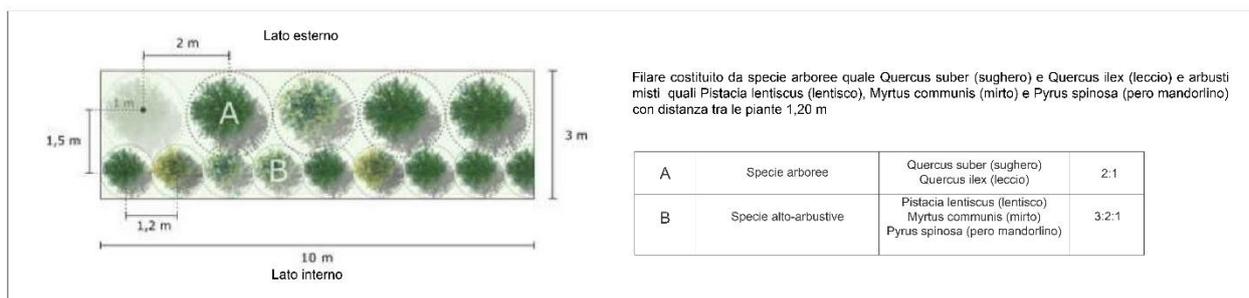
Dettaglio planimetrico della fascia verde di mitigazione
